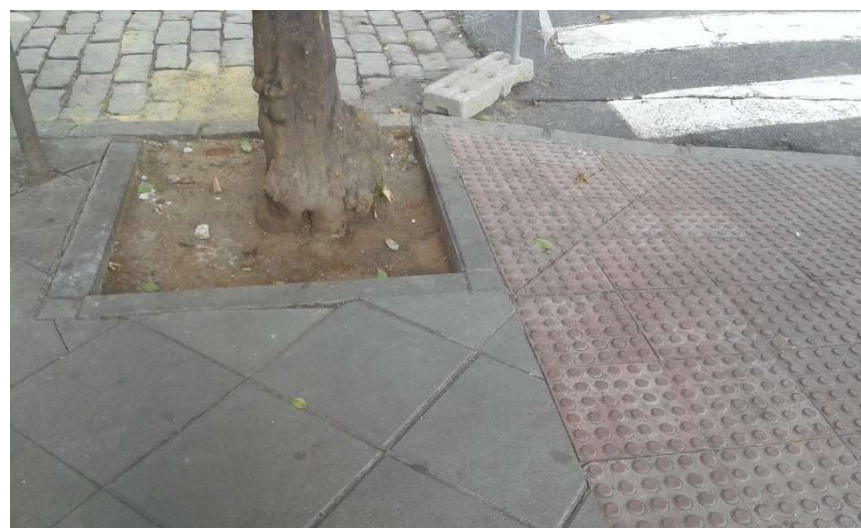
Bordillo delimitación de alcorque de hormigón prefabricado.
